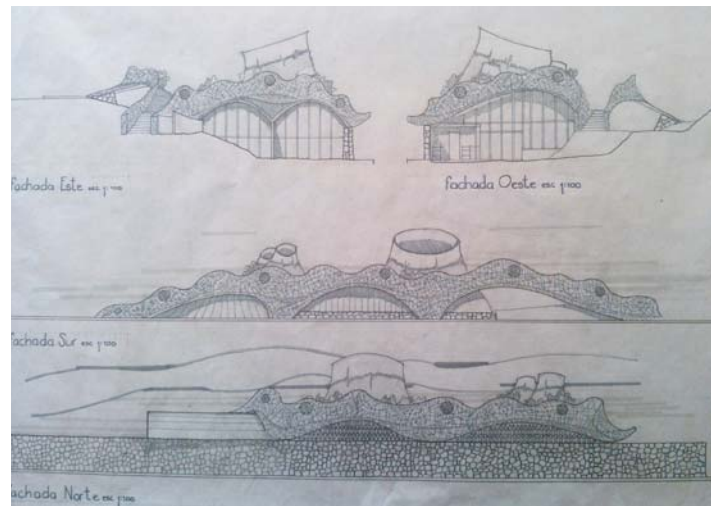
Fachadas del proyecto con las bóvedas, se observa que son un elemento rígido.
